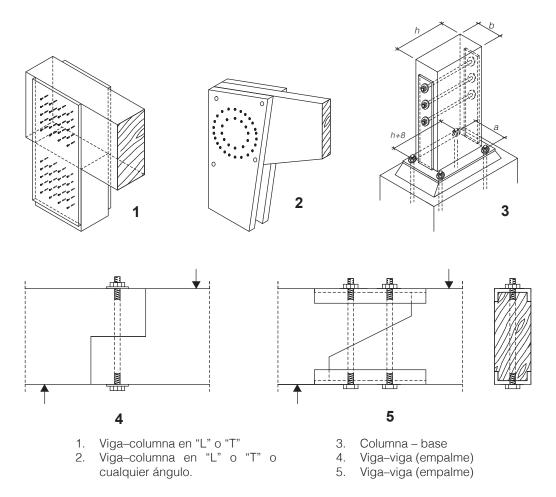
Recomendaciones de conexiones semirrígidas (adaptadas de las referencia 21).
